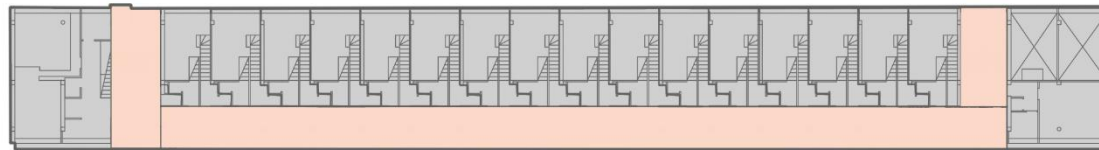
Esquema zonificación planta tercera. Fuente: Elaboración propia
